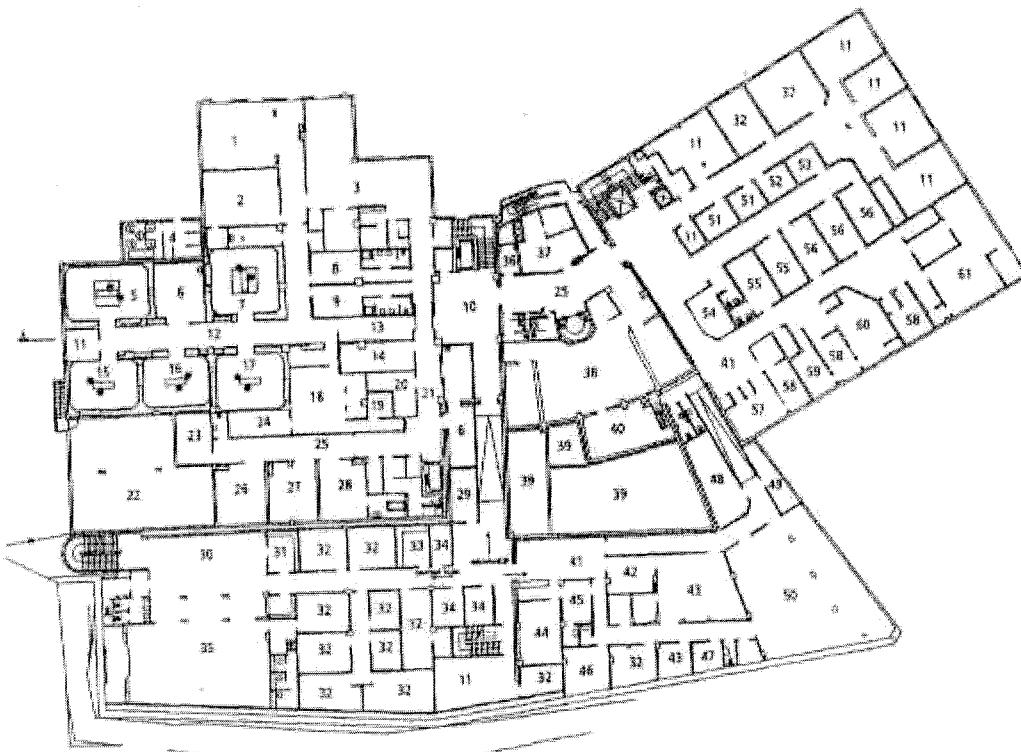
Acıbadem Hastanesi Kadıköy vaziyet planı
